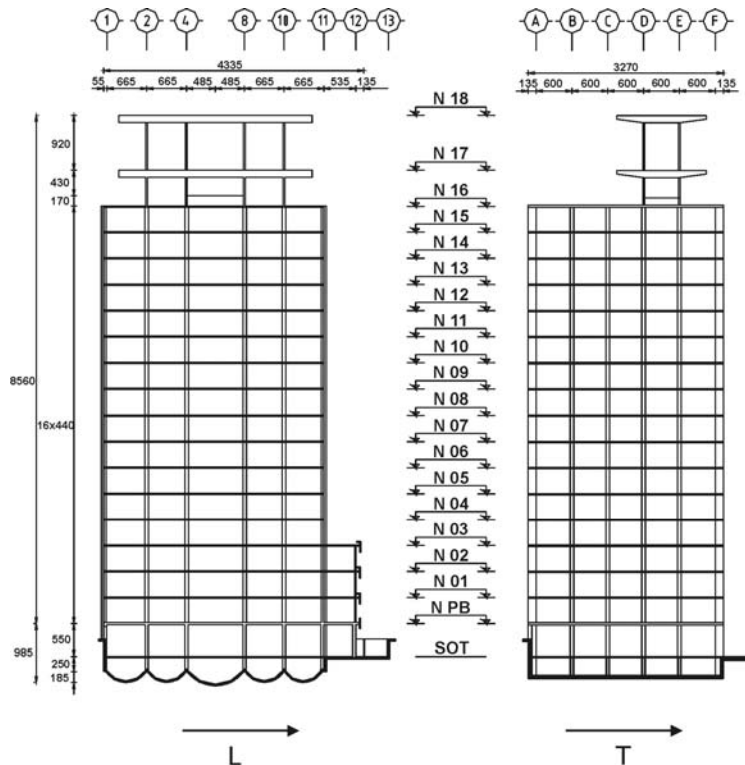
Fachadas Longitudinal y Transversal del edificio (Camargo y Cruz, 2004)
